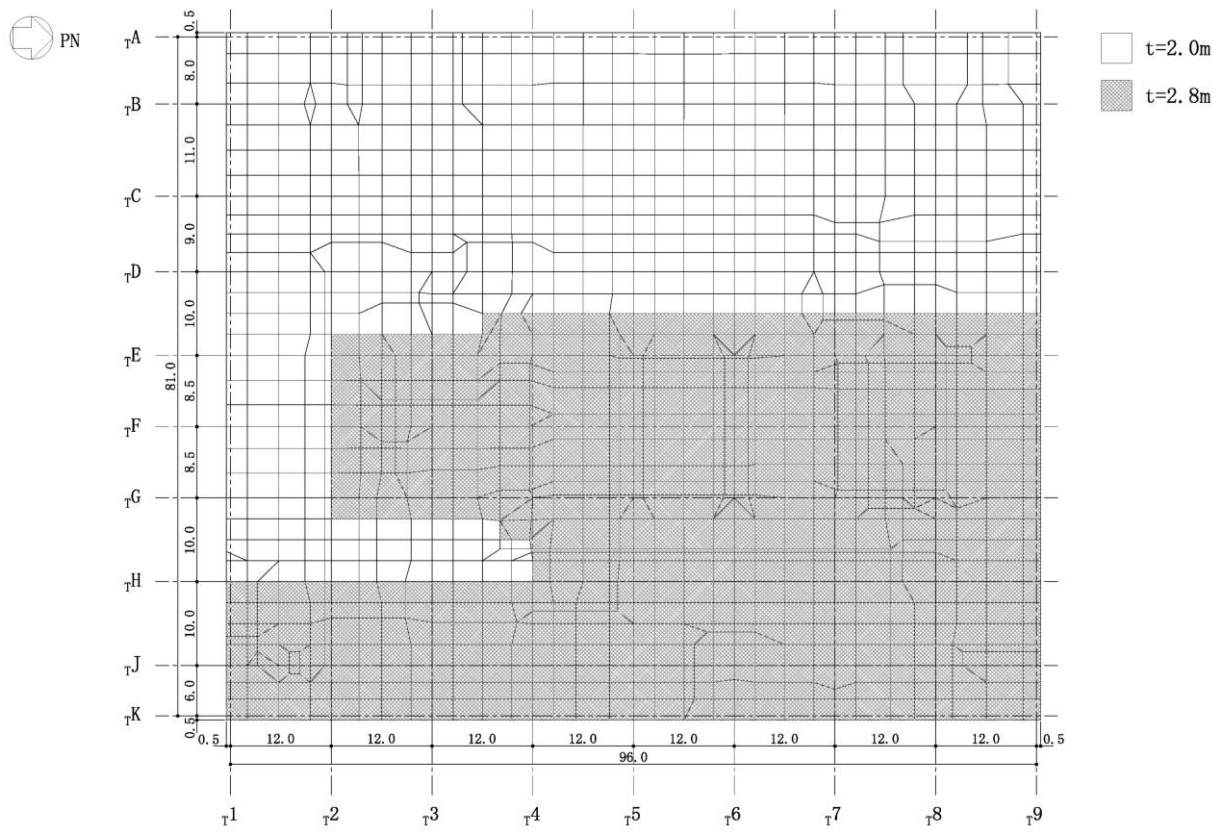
基礎スラブのスラブ厚 (単位 : m)
